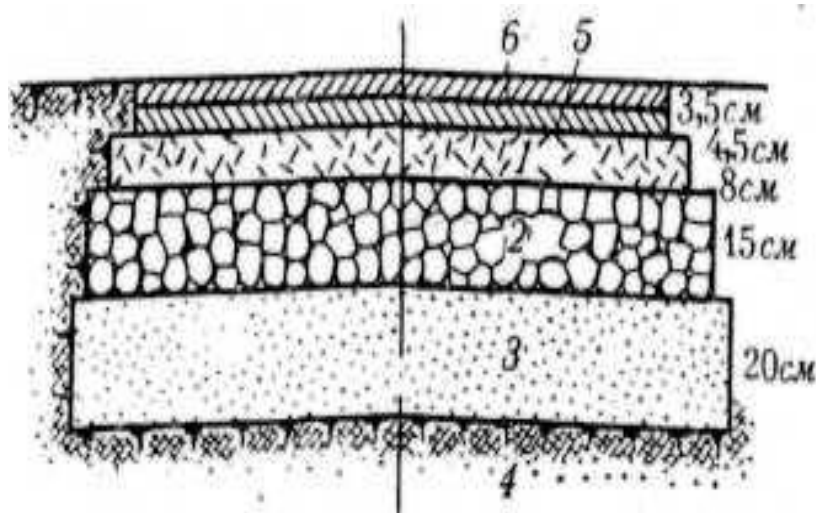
Конструкция нежесткой дорожной одежды капитального типа: 1 – черный щебень; 2 – щебеночный слой; 3 – песок; 4 – грунт естественного основания; 5, 6 – асфальтобетон
